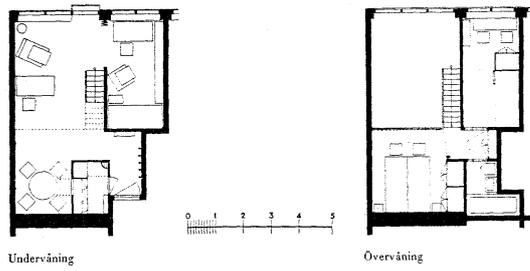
Sven Markelius: Grundriss der Mietwohnung 7.
